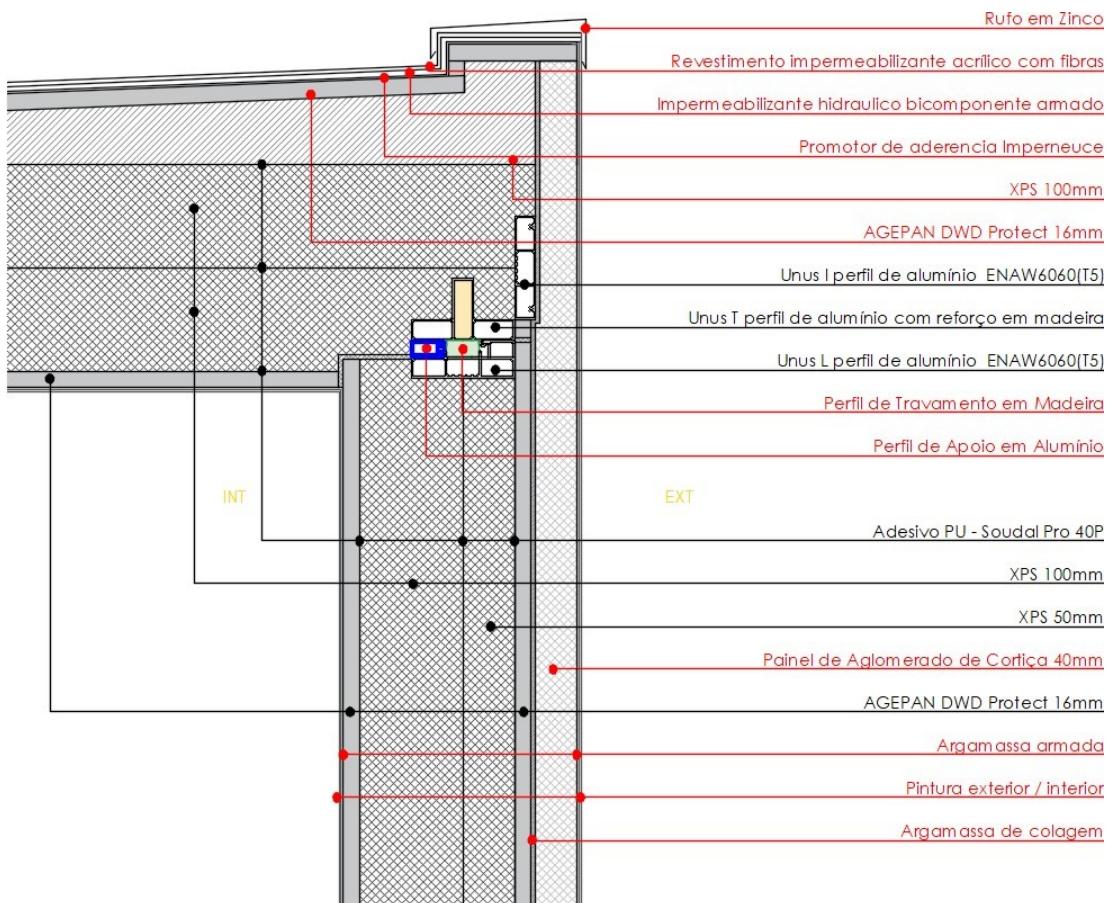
Solução Final – Pormenor construtivo de paredes verticais/coberturas.
